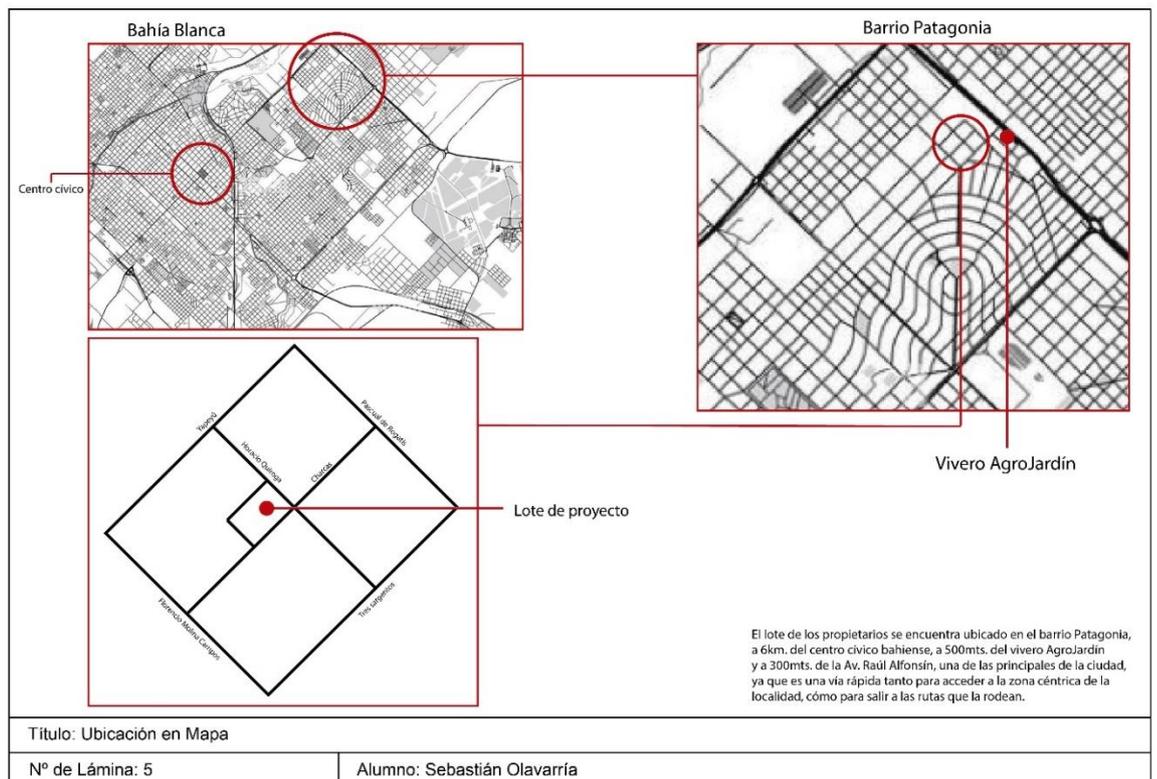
Plano con ubicación espacial de la vivienda a intervenir dentro de la ciudad
